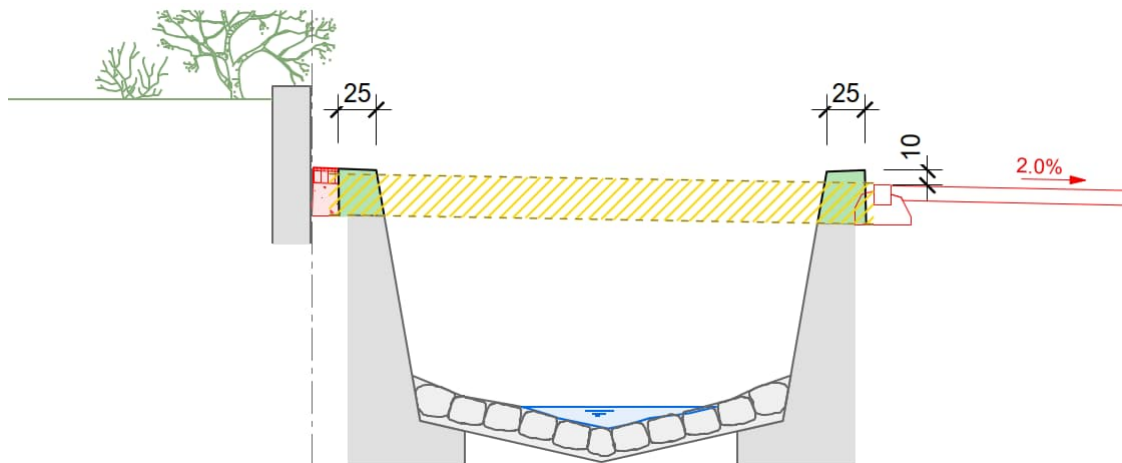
Bachöffnung entlang der Parz. 107 (vgl. Plan Nr. 2-1537.1 / 05)
